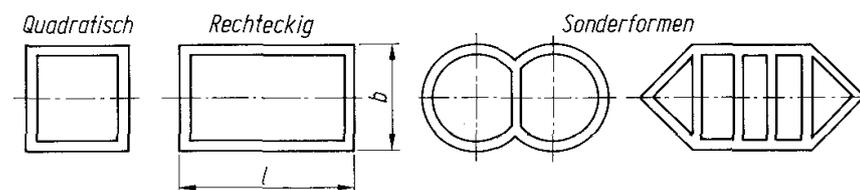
Zweckformen erfordern andere Querschnitte [2]
